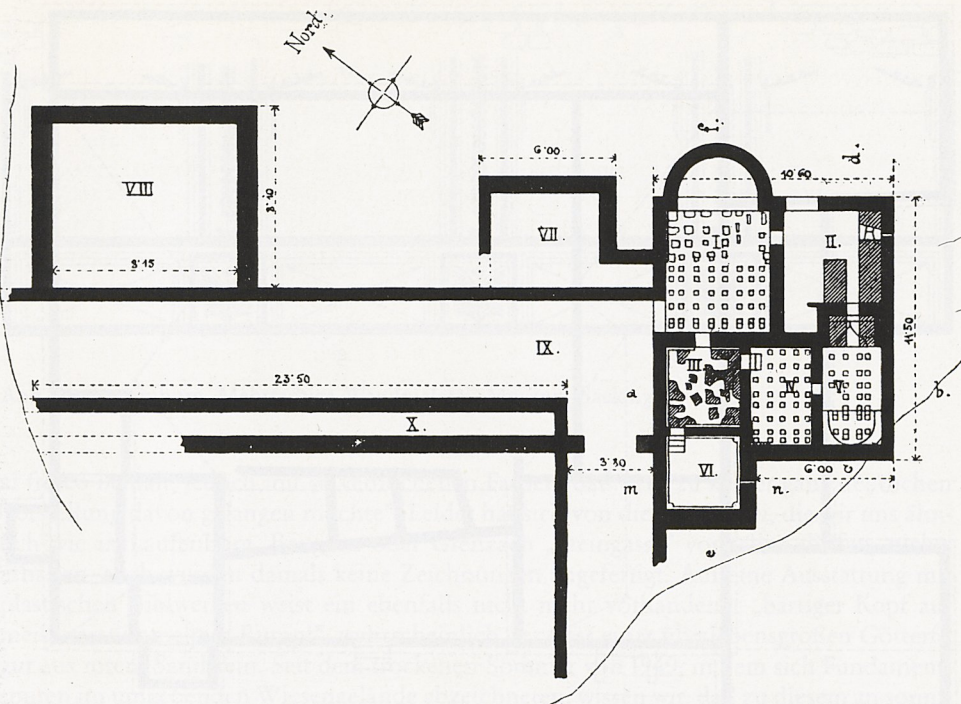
Waldshut, Stadt Waldshut-Tiengen. Grundriß des Wohngebäudes mit Badetrakt.
